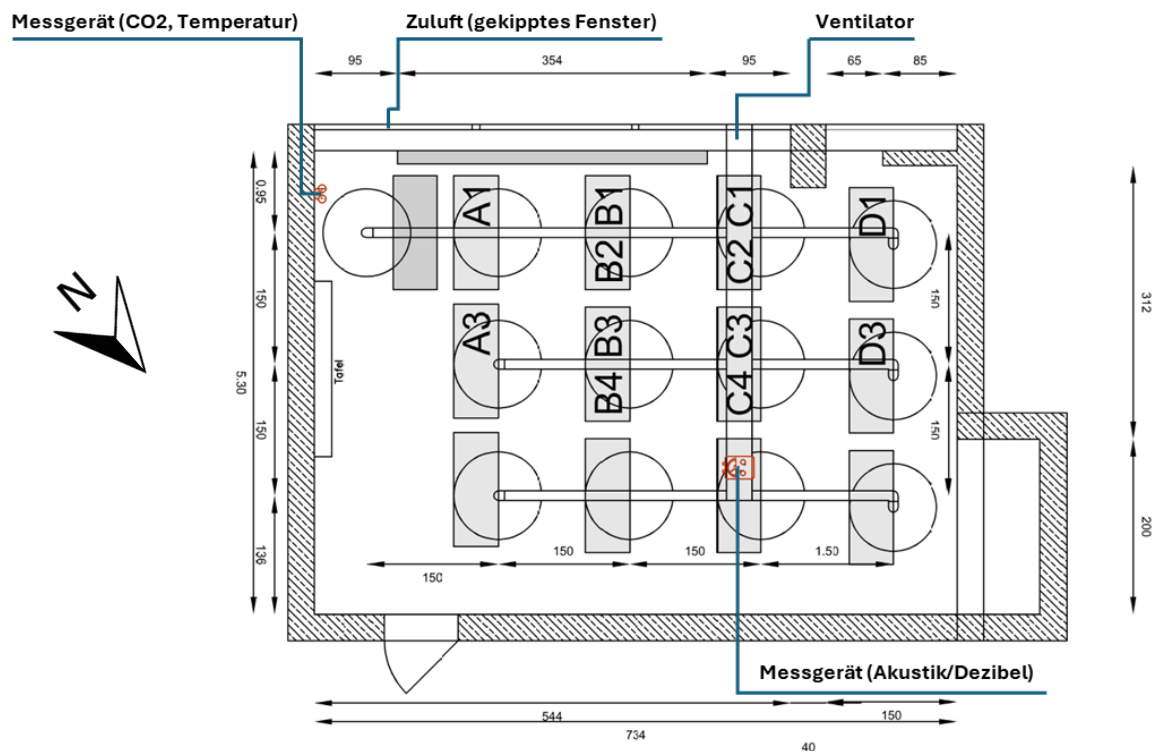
Klassenraum 8.B, Grundrissplan [adaptiert von 23]
